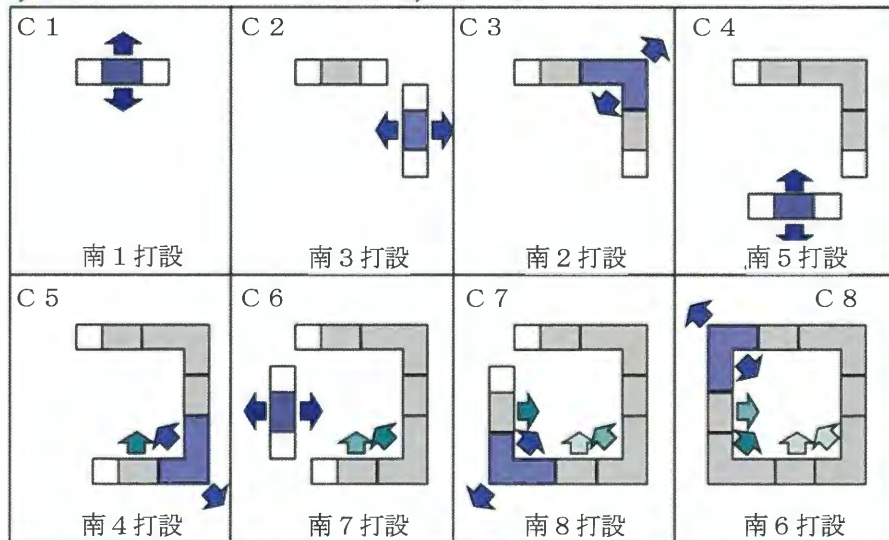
構築ステップ毎のコンクリート打設に伴う地盤への施工圧力の蓄積履歴（南基礎）
